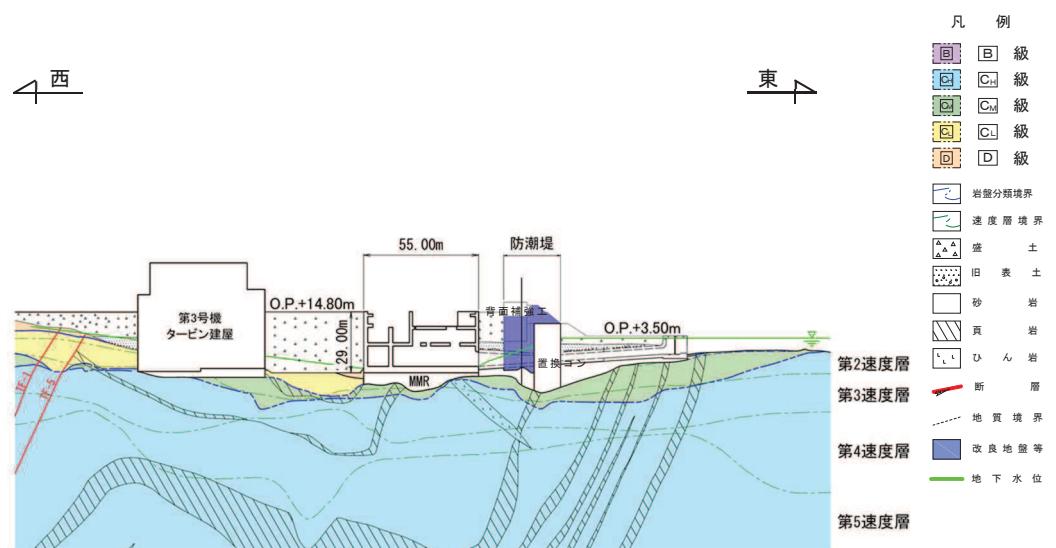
第3号機海水ポンプ室地質断面図 (A-A)
